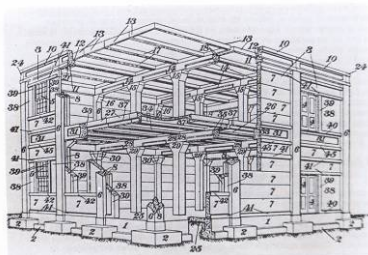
Sistema Unitário de Construção em Betão Prefabricado, patenteado por John Conzelmann em 1912. Em, MORRIS, A. E. J. – «El Hormigón Premoldeado en la Arquitectura», p.66.
